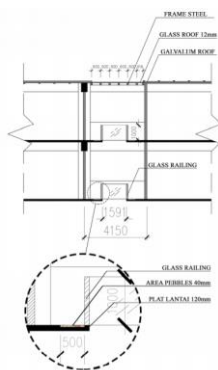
Akses Tangga Ground ke Lantai 2
